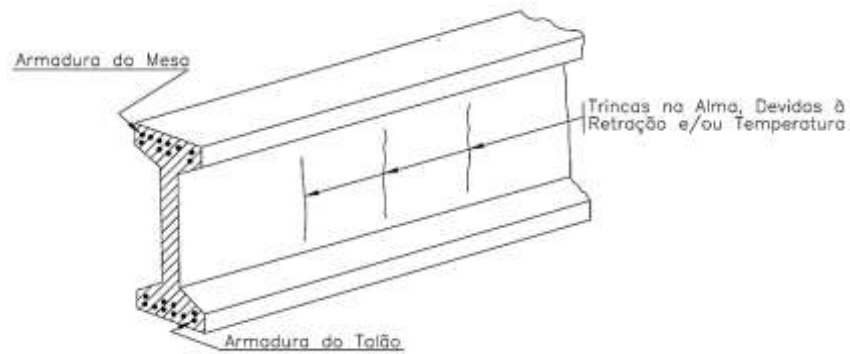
Fissura ou trinca devido a retração.
